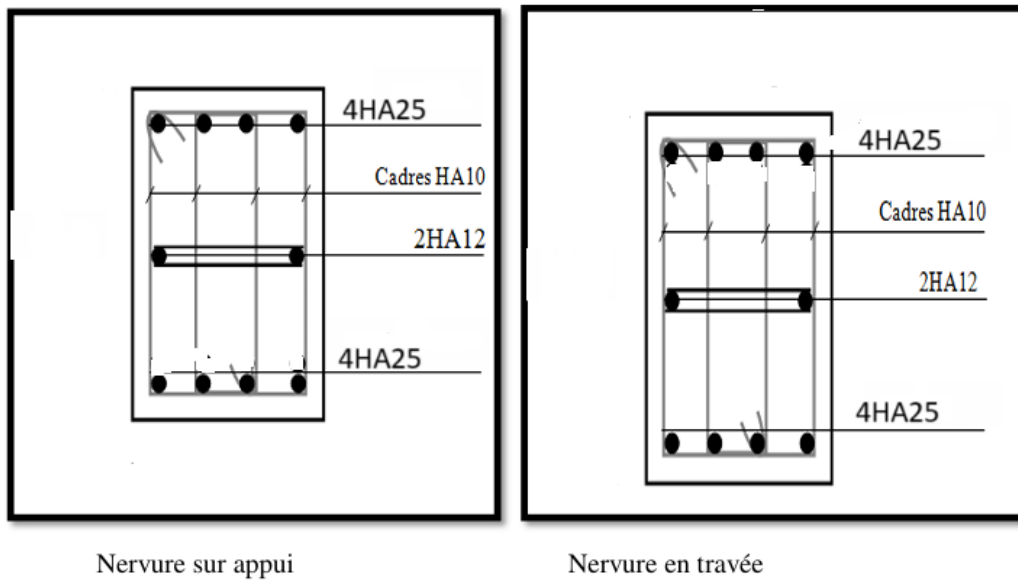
ferrailage sur appui Et en travée de nervure.
